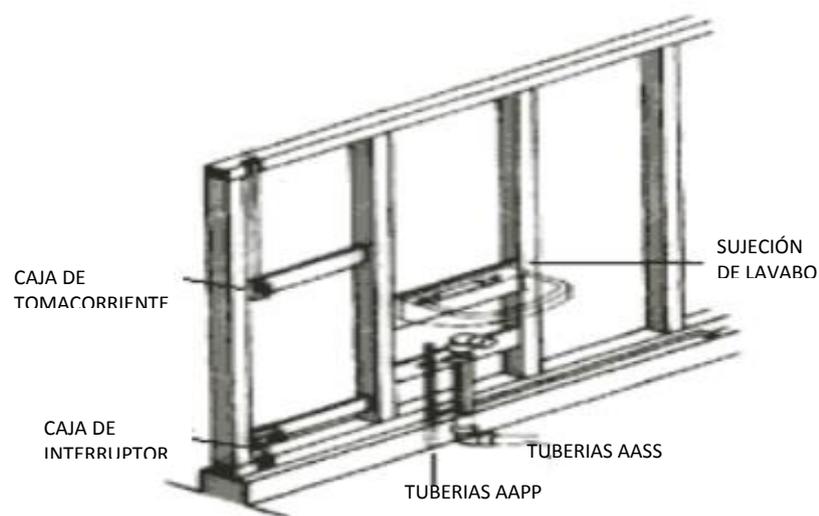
Travesaños de madera empleados para la sujeción de instalaciones
